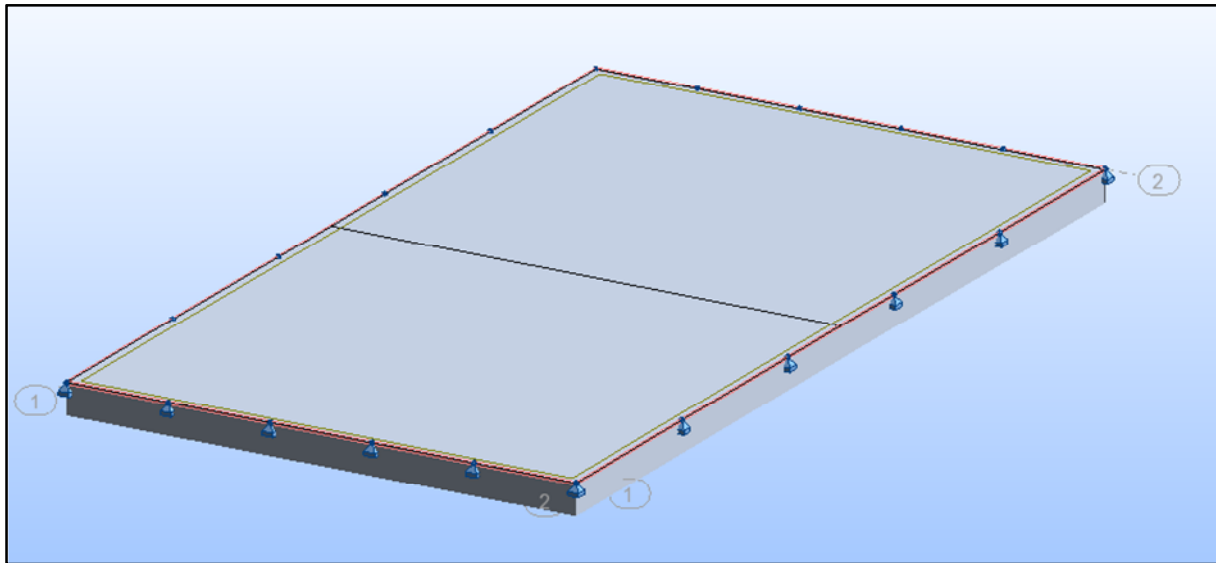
Vue en 3D de la dalle de transition (Robot)
